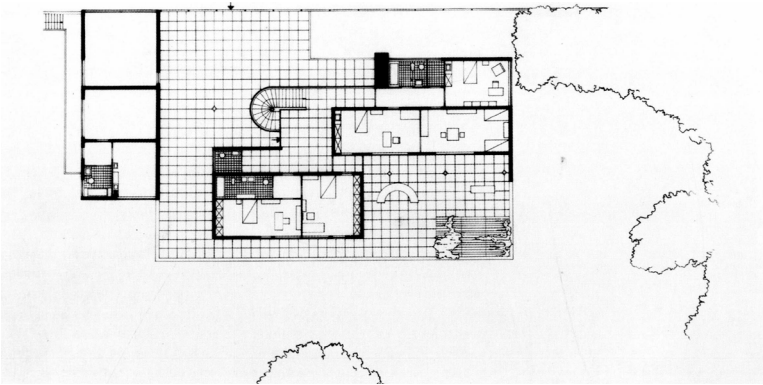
Villa Tugendhat. Plano de planta baja con garaje, habitaciones y acceso.
